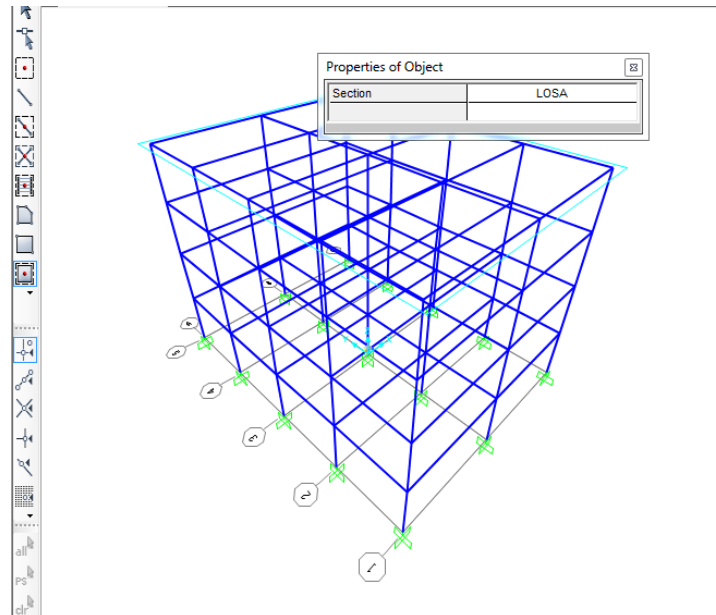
Asignacion de las vigas para el 1er y 2do piso.
